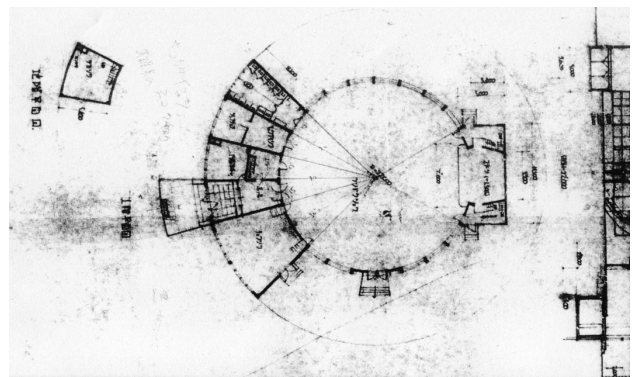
1階平面図、丸体育館・扇形教室、1956、
